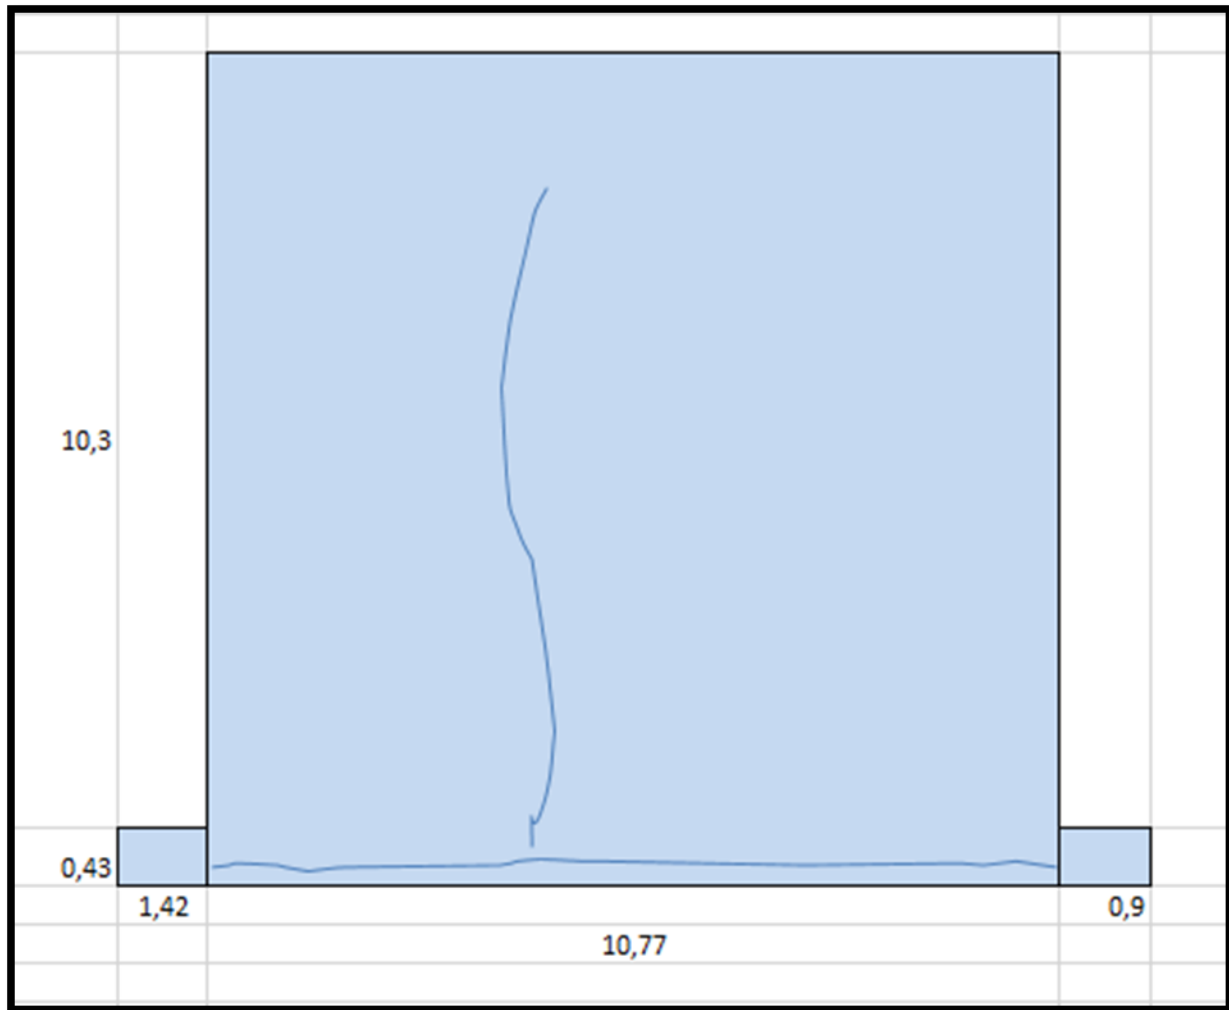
Alzado de la TE-801E con sus elementos y levantamiento de lesiones – costado sur (Fuente: el autor).
